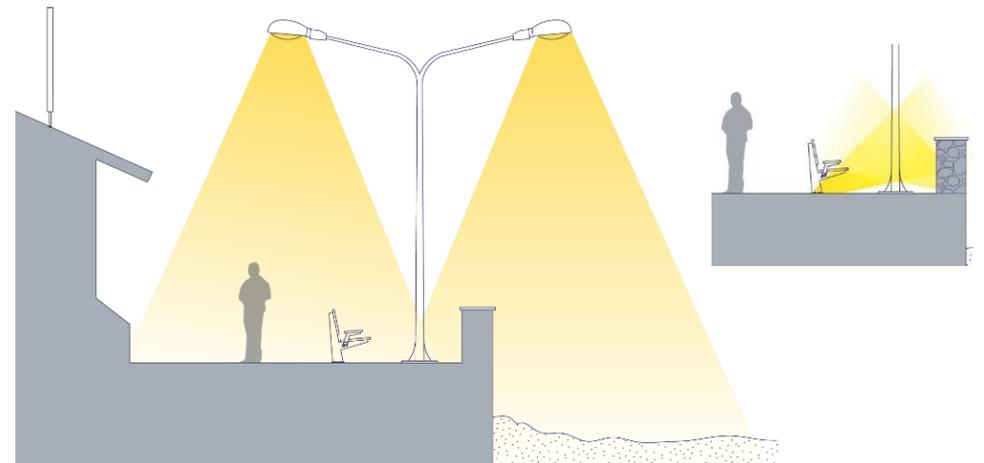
Perfil de calle propuesta de luminaria y pasarela hacia la playa, además de la situación actual, 2023, Elaboración propia CMN
